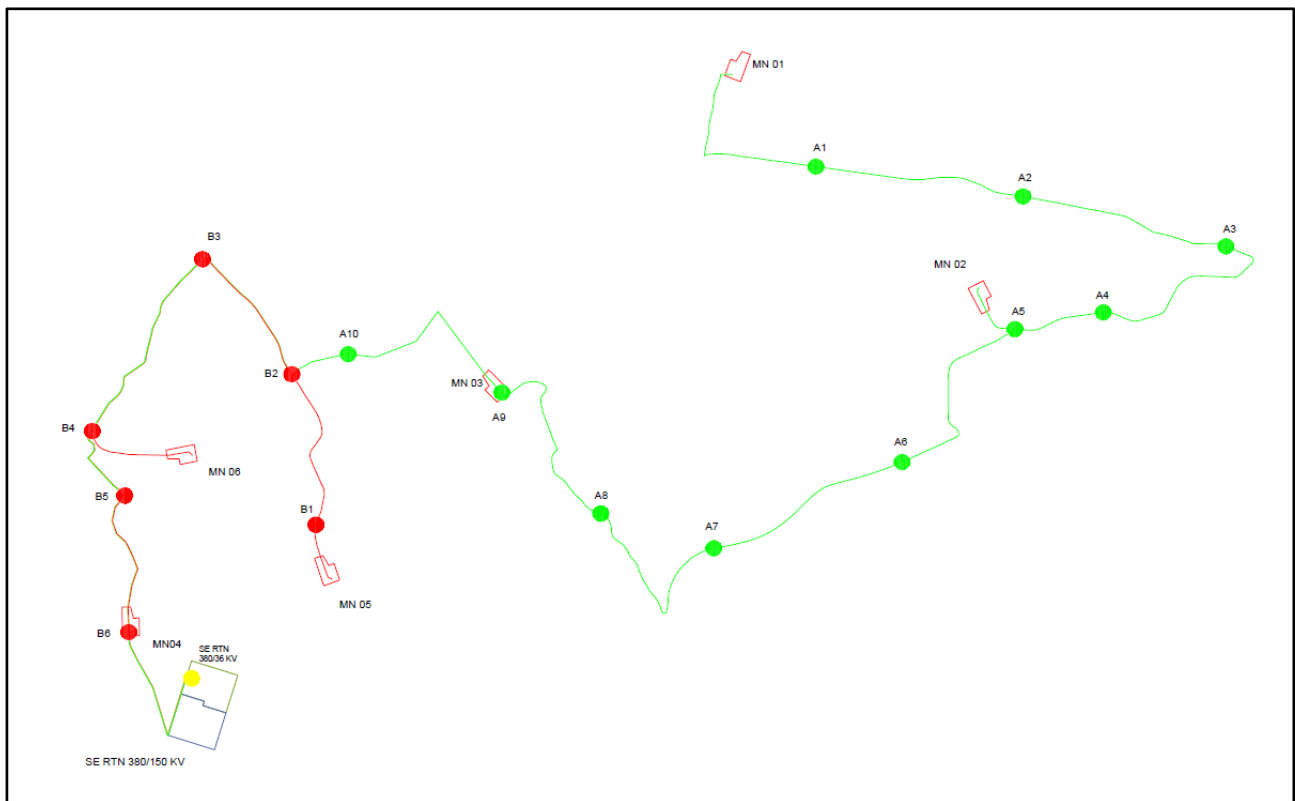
Planimetria di distribuzione linee a 36 kV dell'intero impianto
